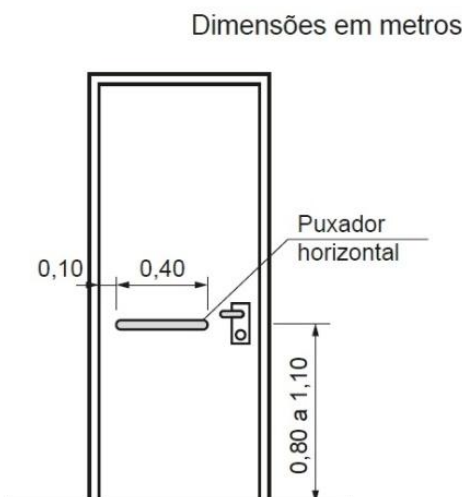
Dimensões de largura e instalação da barra metálica na porta do sanitário, referência NBR 9050/2015.
